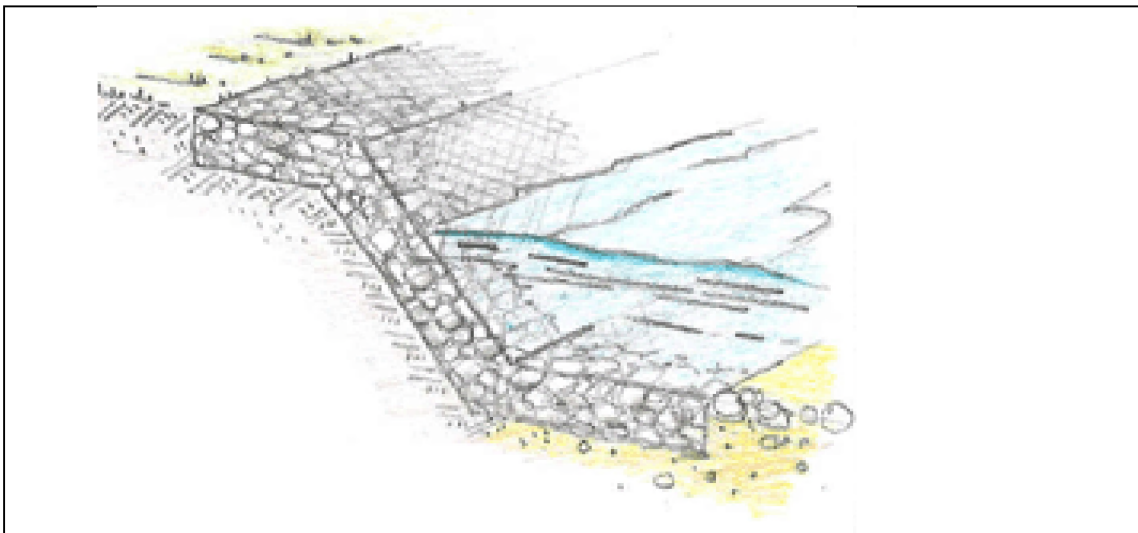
coupe transversale d'une protection par Matelas-gabions
